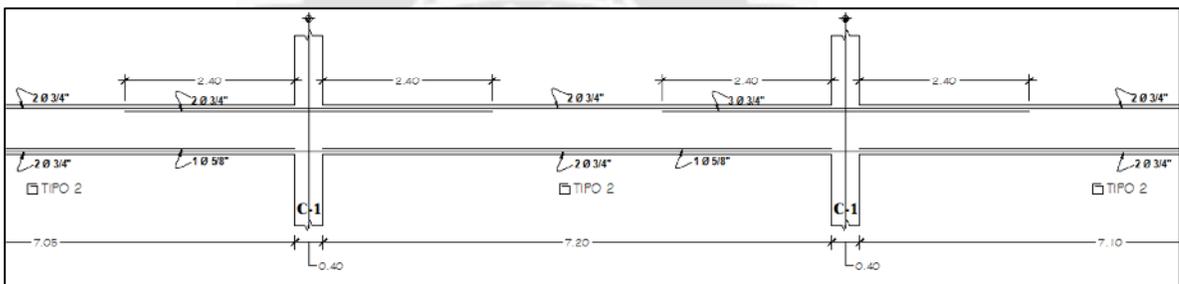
Distribución Final del Refuerzo por Flexión para la Viga en Estudio.
